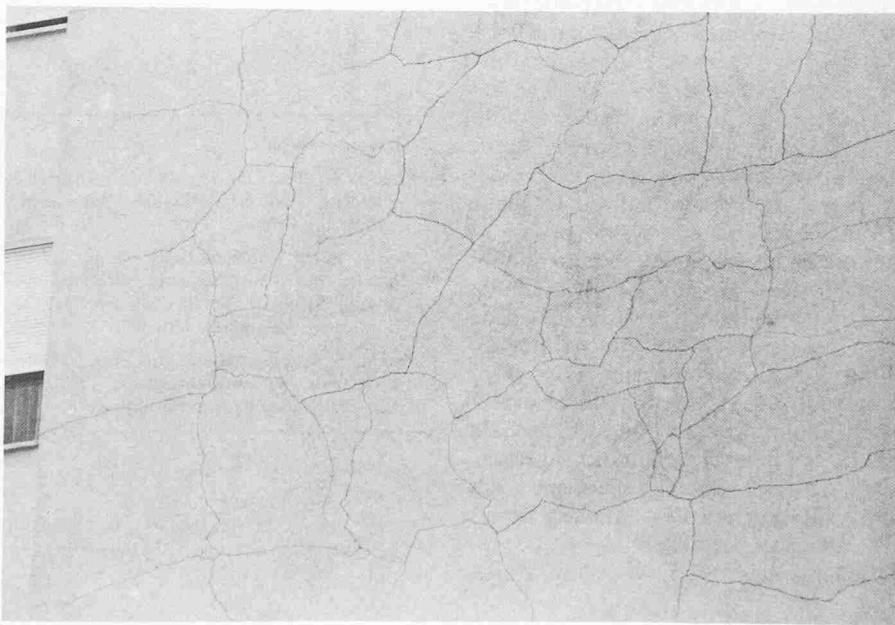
Nichtsanierter Hochhaus. Fassadenausschnitt: netzartige Schwindrisse im zu hoch dosierten Verputz
